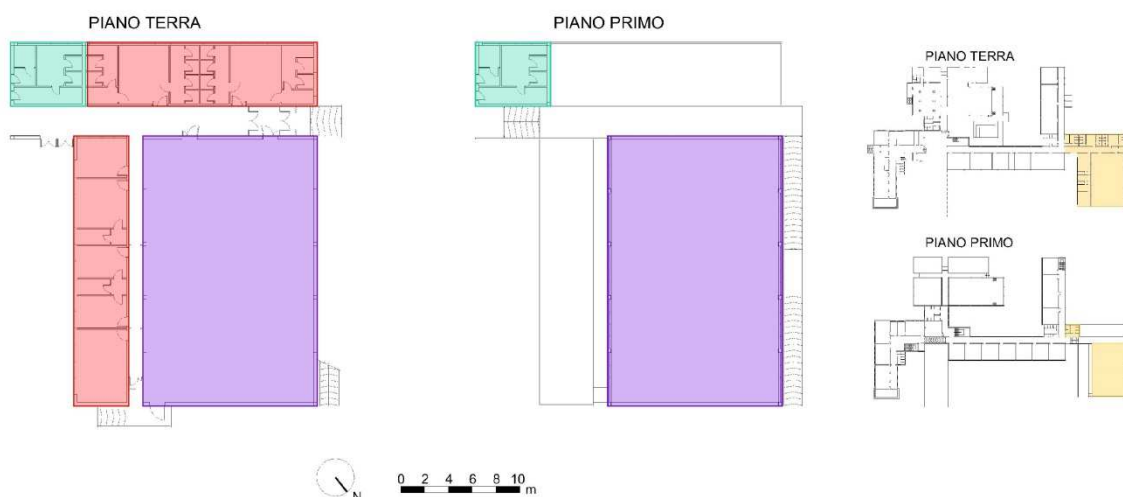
Distribuzione in pianta delle aree afferenti a diverse tipologie strutturali, tra loro collegate da solai e travi, e localizzazione del corpo nel complesso degli edifici
